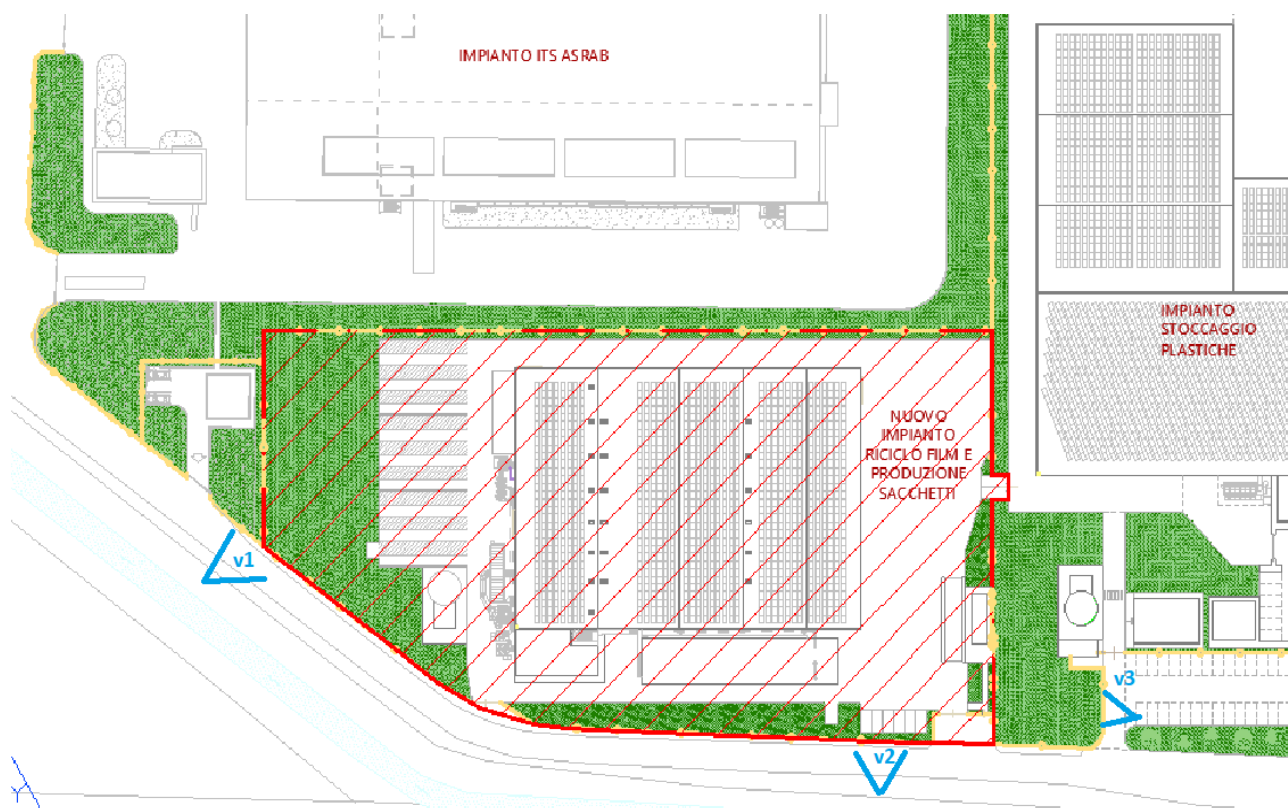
Pianta chiave documentazione fotografica dell'area d'intervento
